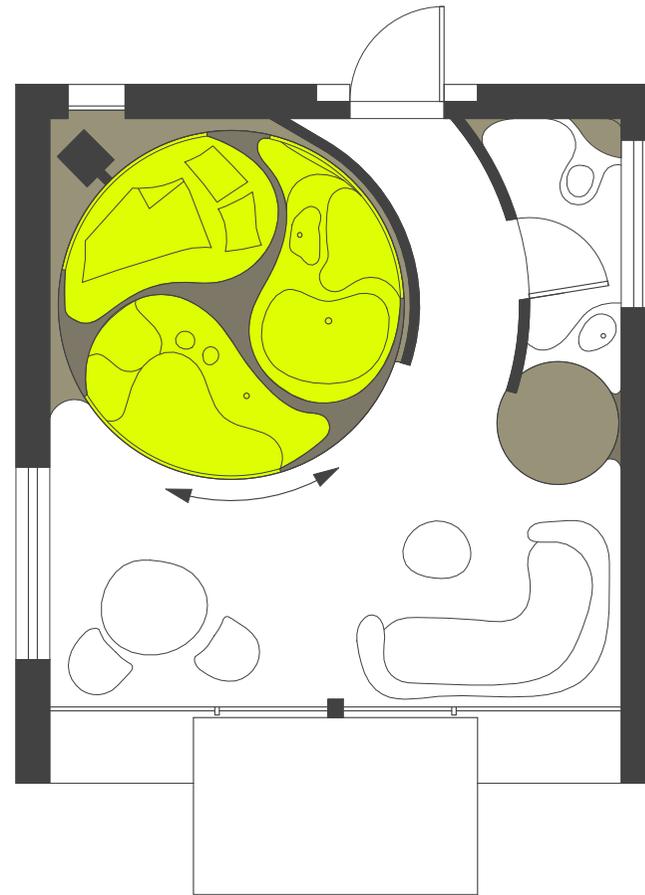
Grundriss Rotor-Modulhaus, eigene Darstellung
